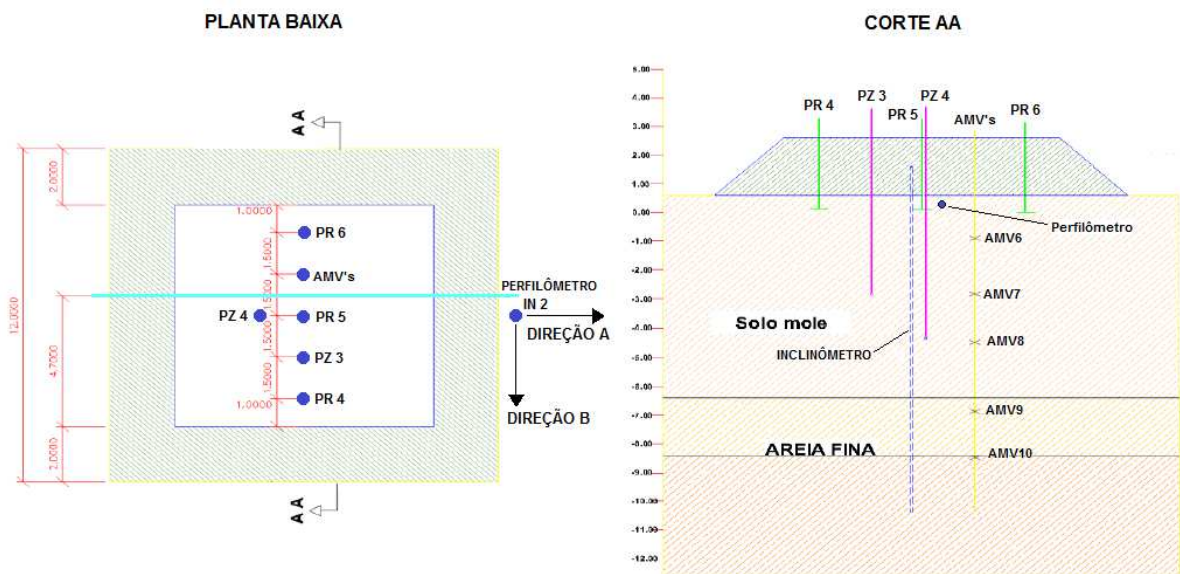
Localização dos instrumentos no aterro teste B (com CPR Grouting).
